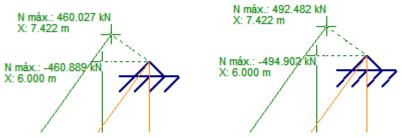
| Unión N° 3 Reticulado Norte – Sur.
